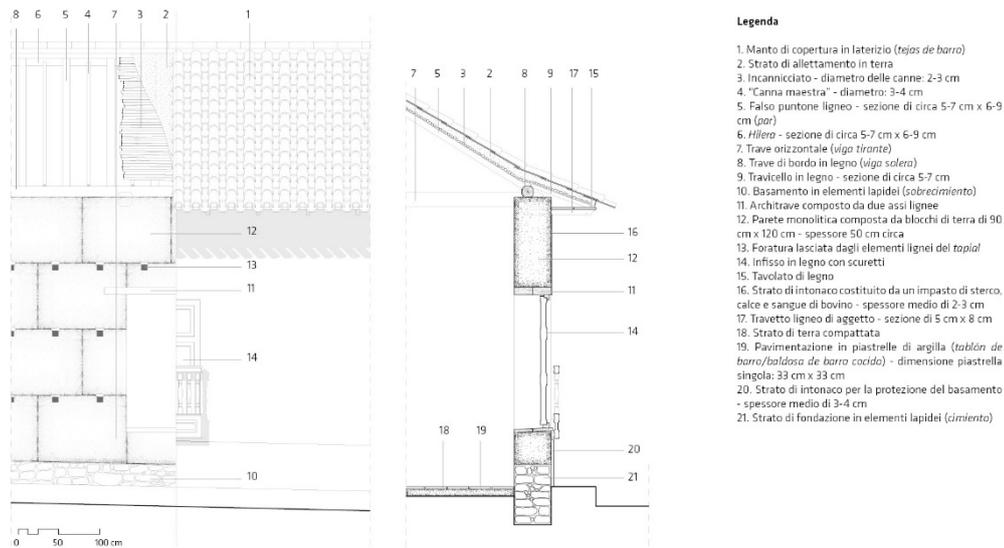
Modellazione di un edificio analizzato– Prospetto con sfogliato e sezione di un muro maestro
